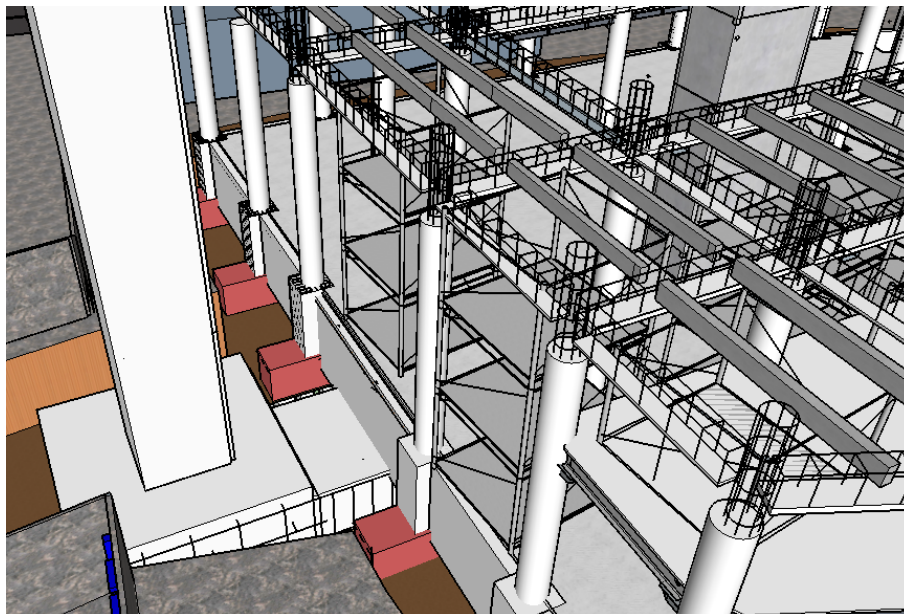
Render de vigas en losa nivel Vestíbulo
